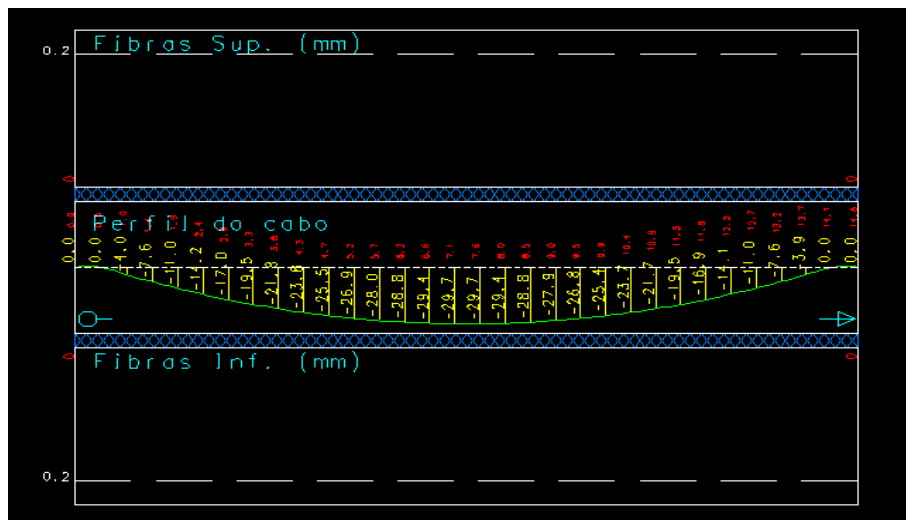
Fissuração viga V12 da cobertura (CAD/TQS)
